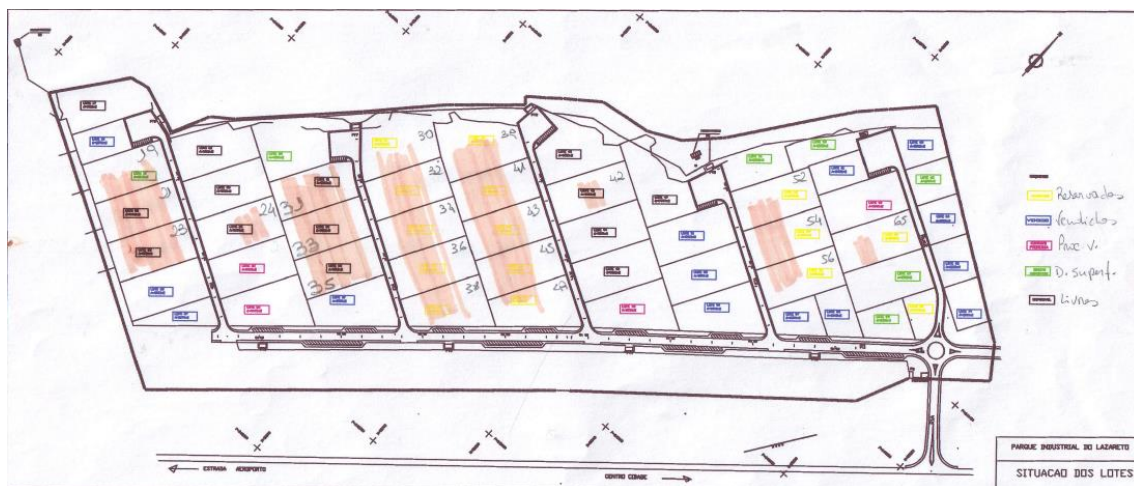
Planta e situação dos lotes do Parque Industrial de Lazareto.
